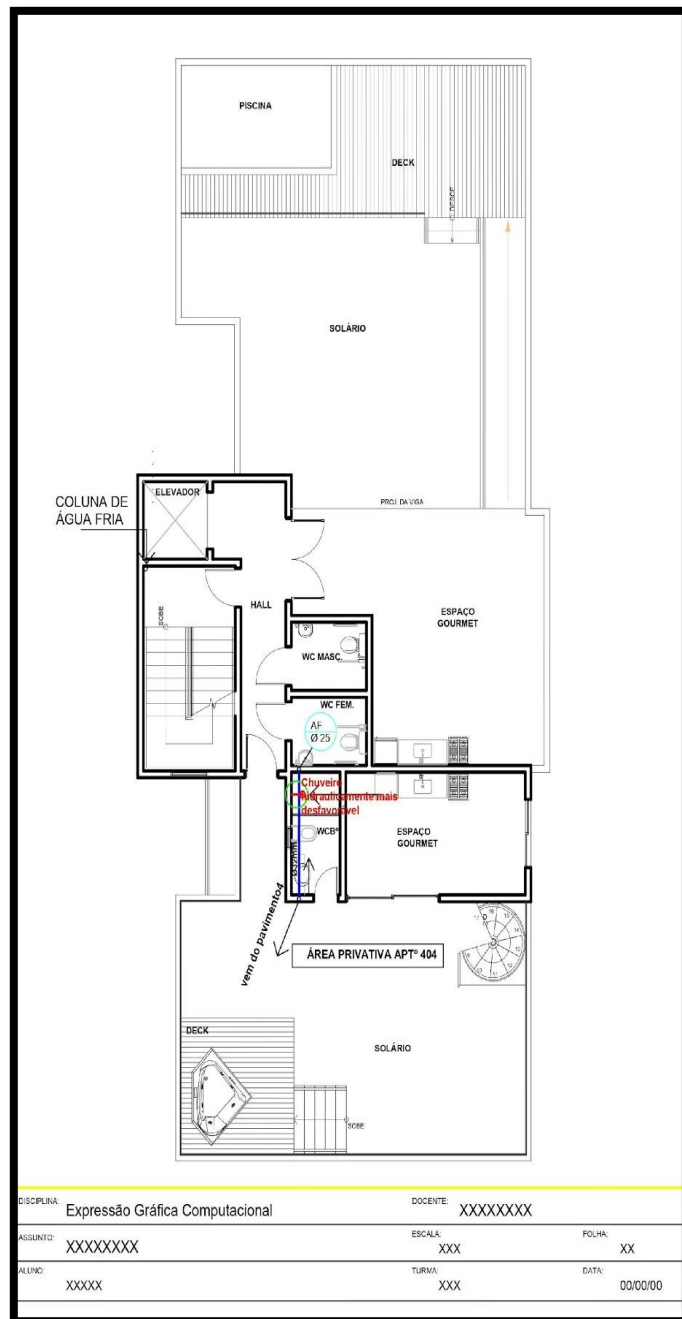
Planta baixa cobertura do apartamento (sem escala).
